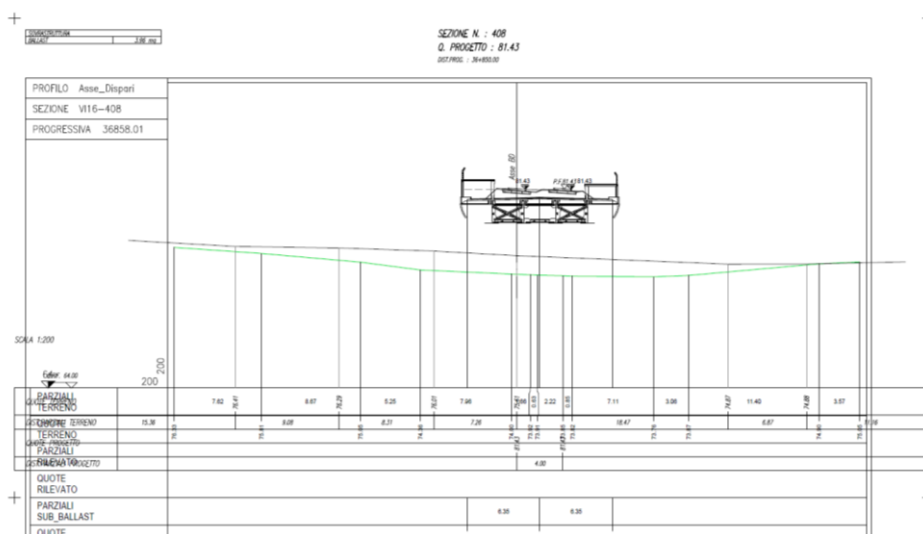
Sezione trasversale sulla spalla SP1 – differenze quote terreno PD/Rilievo
